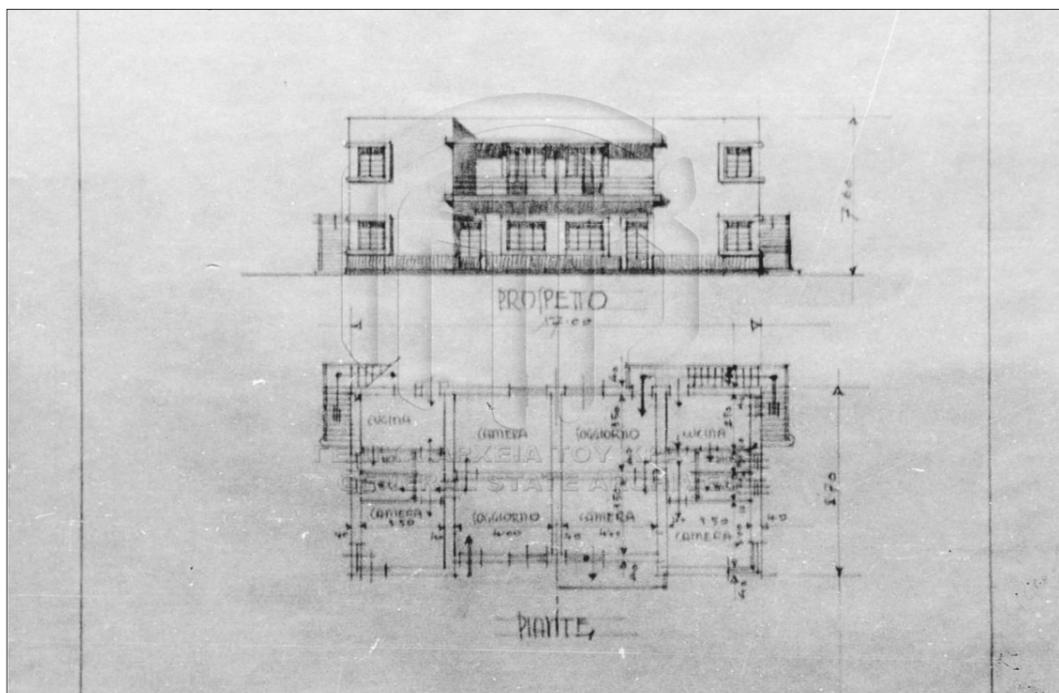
case sottufficiali 1.2, piante prospetto, sc. 1:100
